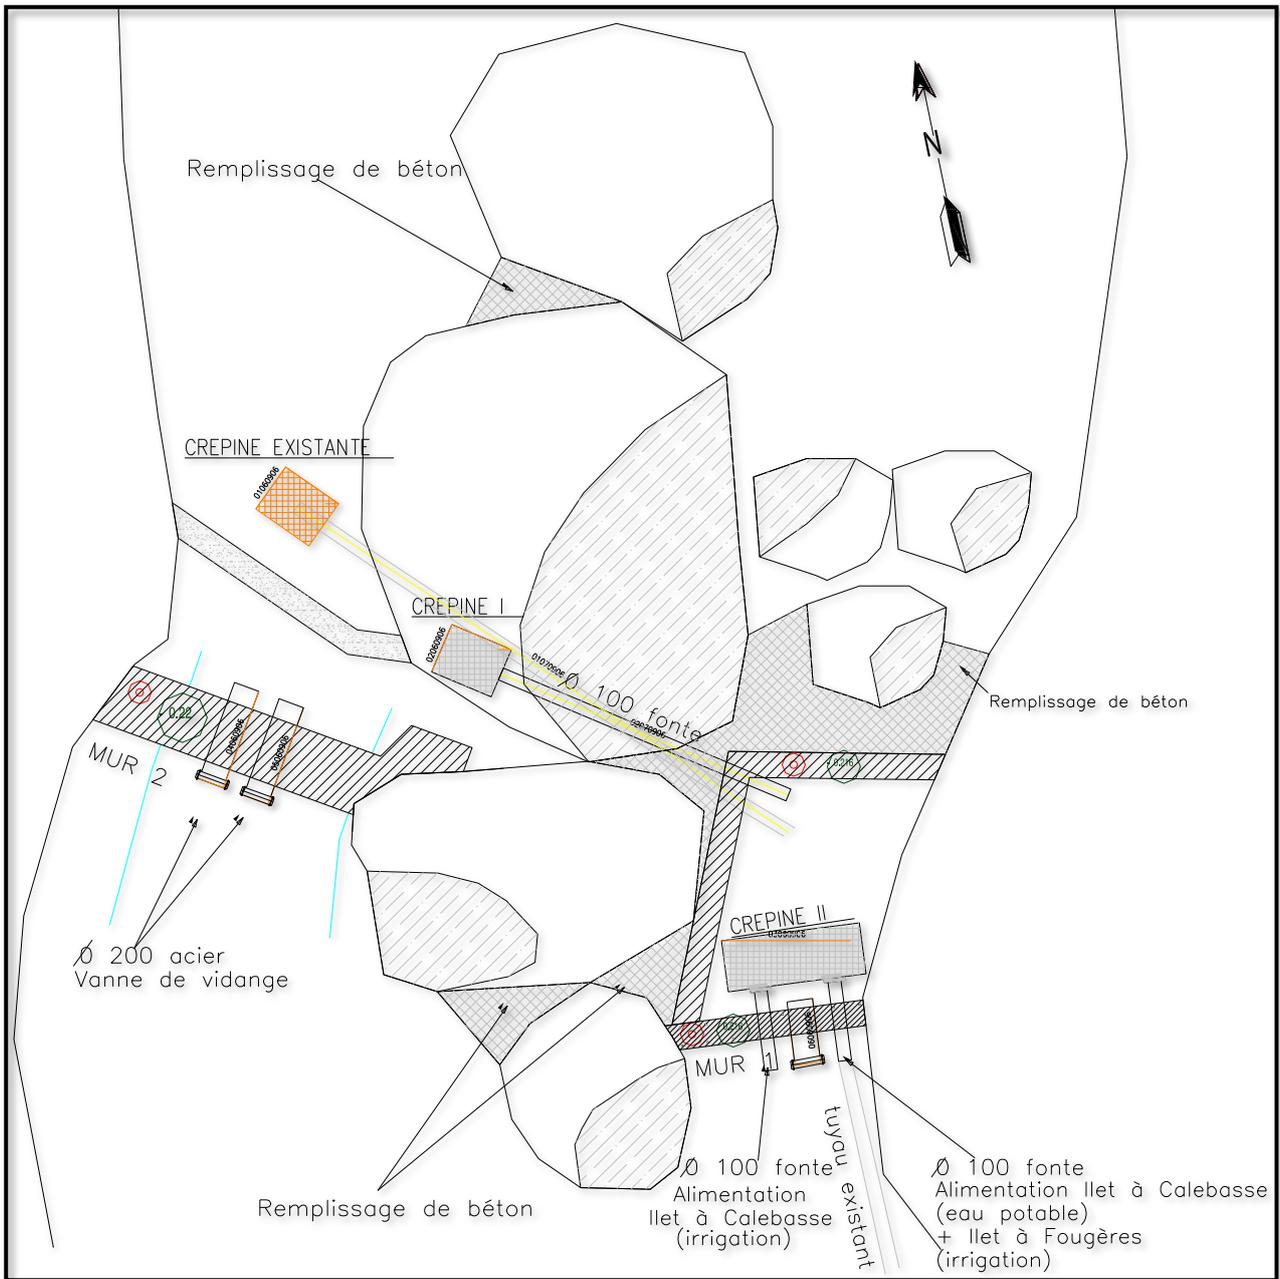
Plan du captage Calumets Haut (source : plan du réseau de la commune)
